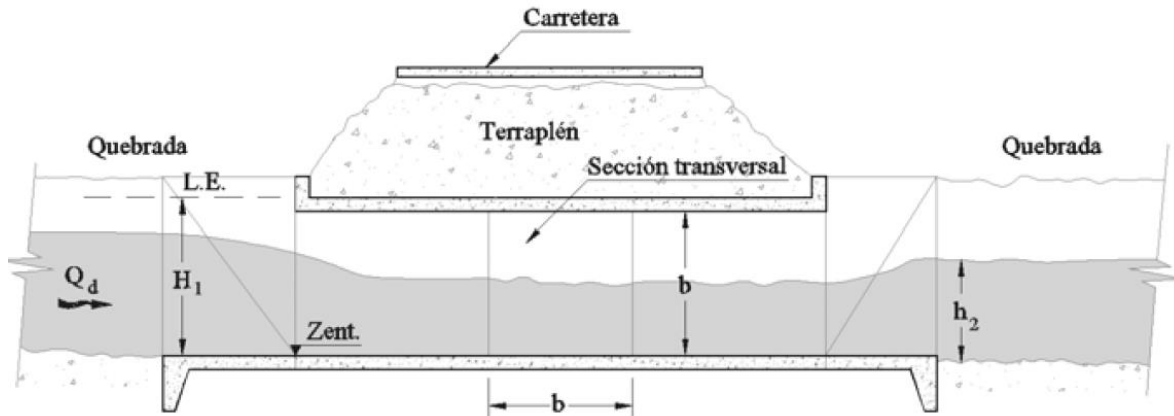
Perfil longitudinal de una alcantarilla (Mery M., 2013).
